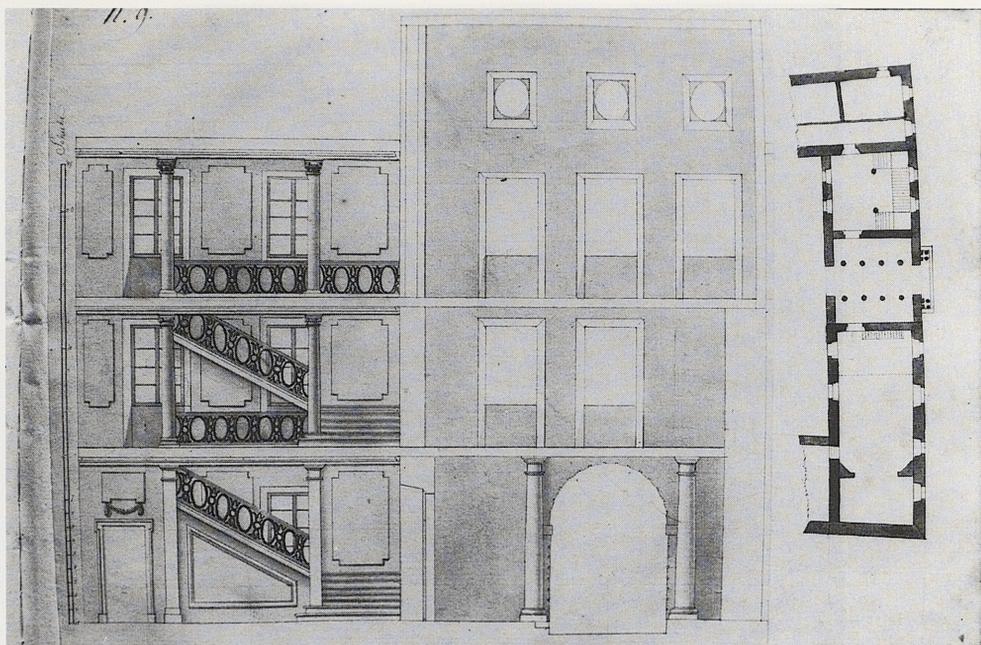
Schloß Haltenbergstetten. Entwurfszeichnung von Gottlieb Ernst 1803. Das Blatt zeigt einen Aufriß des östlichen Mittelbaus mit dem Treppenhaus und den angrenzenden Räumen über der Toreinfahrt. Rechts ein Ausschnitt des Erdgeschoßgrundrisses mit Schloßkirche, Toreinfahrt und Treppenhaus (von Süden nach Norden).
